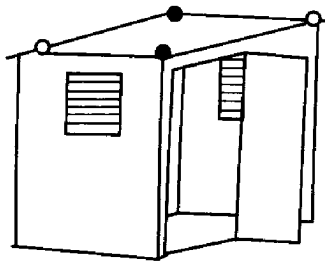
钢筋电渣压力焊机活动房
